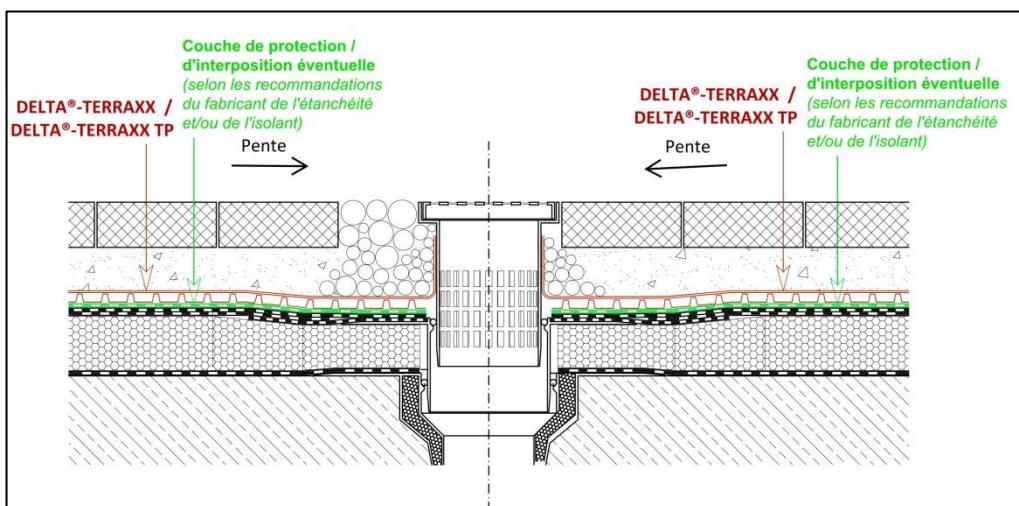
systèmes de recueil des eaux pluviales avec membrane d'étanchéité bitumineuse + DELTA®-TERRAXX / DELTA®-TERRAXX TP (protection lourde avec dalles ou pavés)
